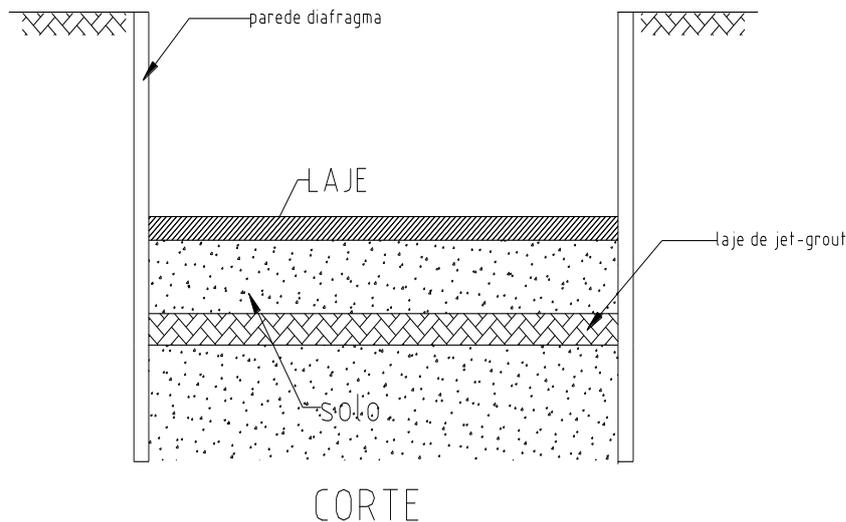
Esquema da obra provisória para a escavação da Bolsa de Valores do Rio de Janeiro
